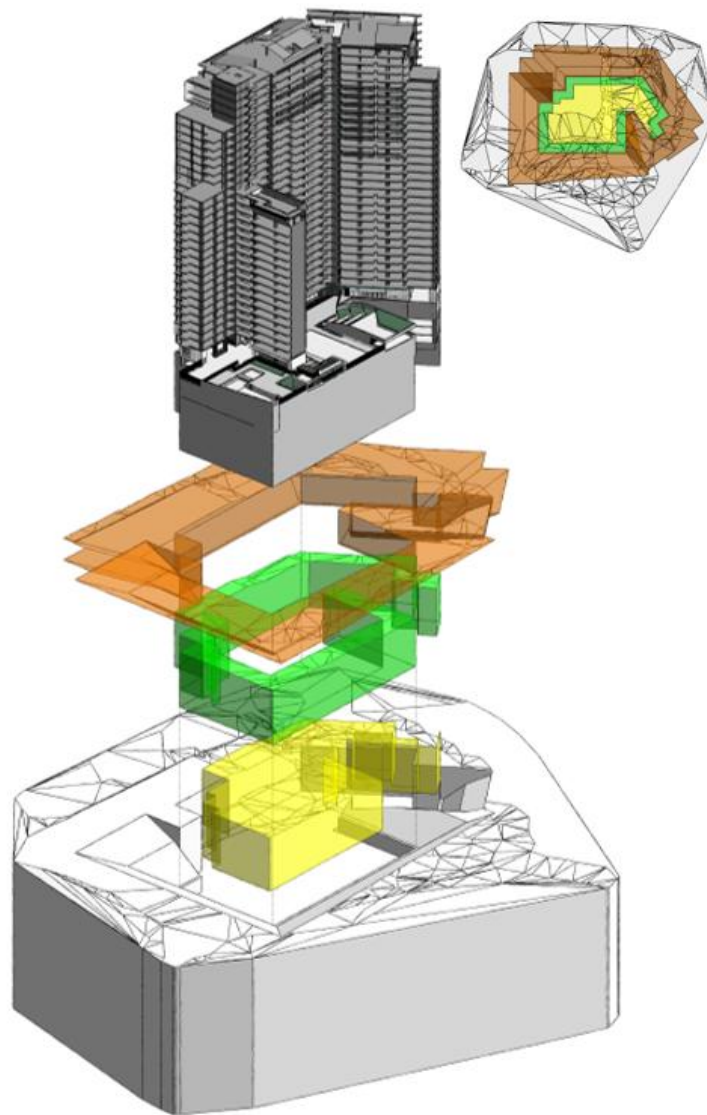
Montaje topografía. Fuente: Creación propia, Revit (2018)
